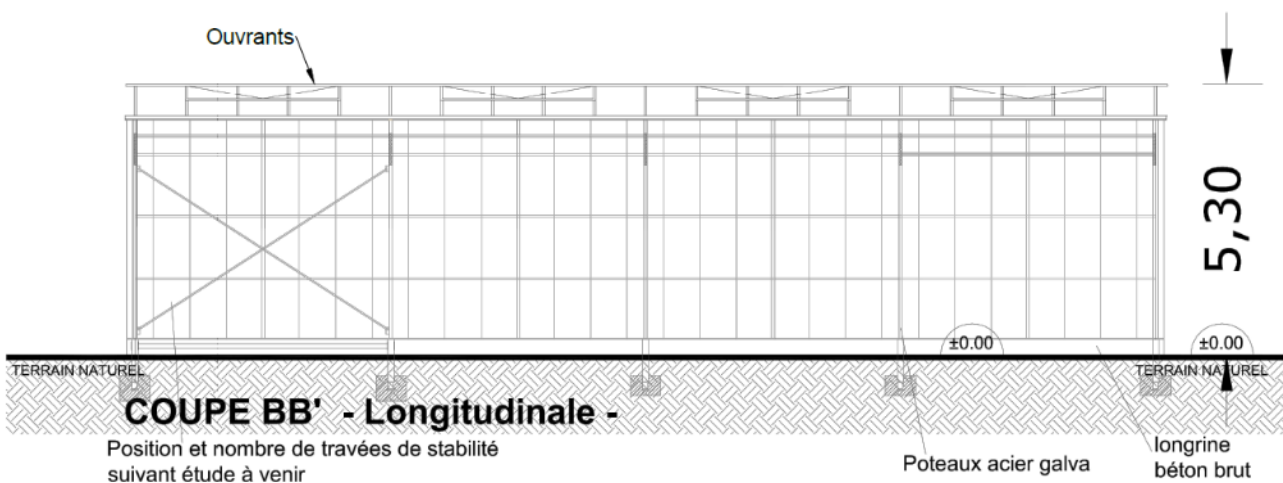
Coupe type serre multi-chapelles, côté long pan. Reden.
